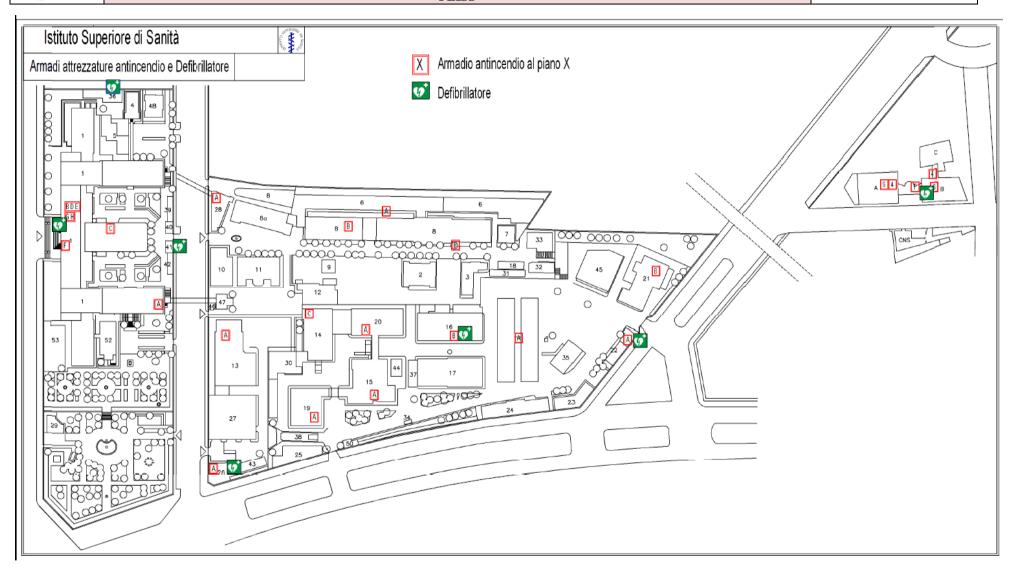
Planimetria Ubicazione Armadi D.P.I e Defibrillatori.
